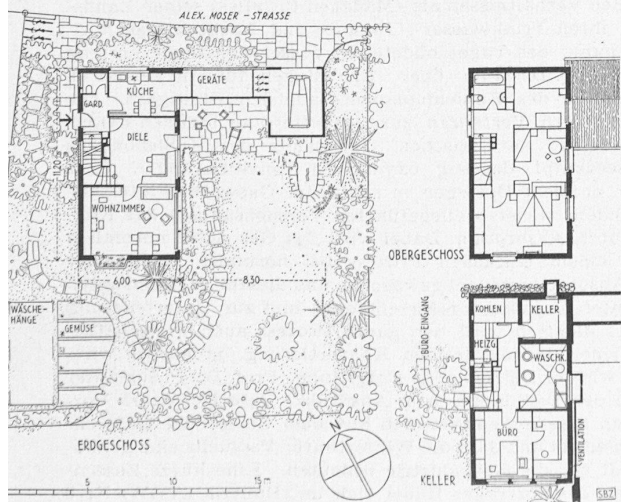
Grundrisse, Masstab 1 : 400
